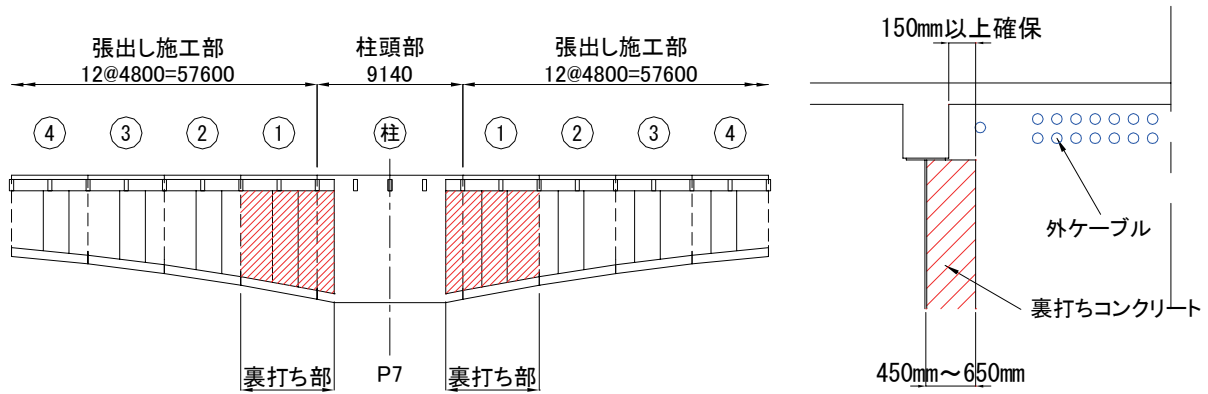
裏打ちコンクリート配置図 (P7 張出し施工部, 概要図)
